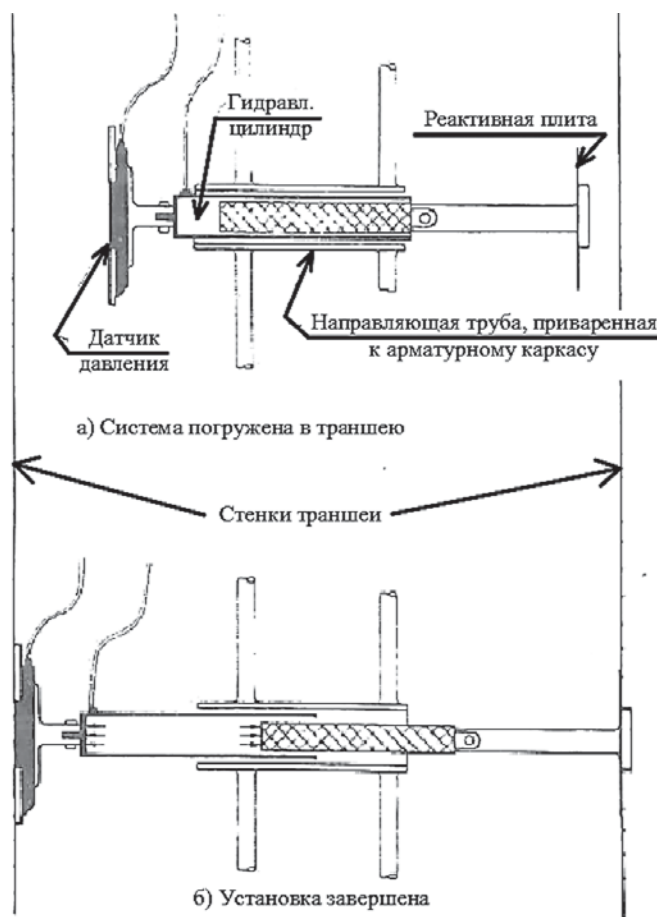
Схема установки датчиков, измеряющих давление свежего бетона на контакте грунт/бетон (опытная захватка стены в грунте в Осло) [7]
